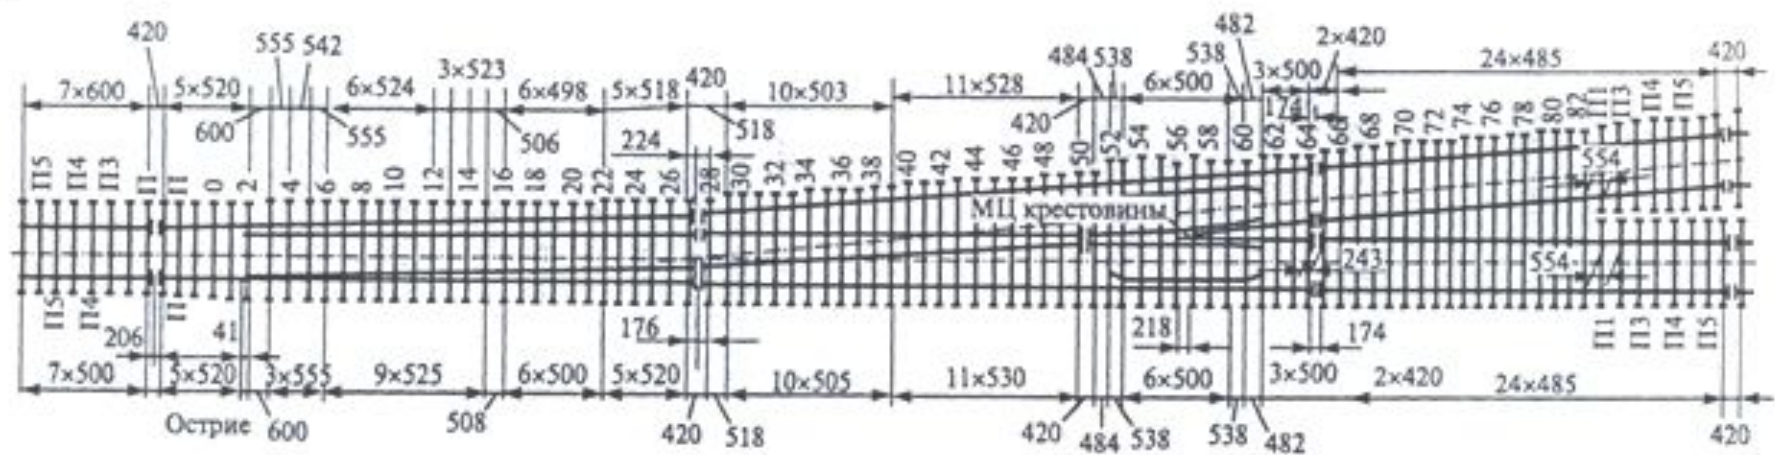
Этюра укладки (а) и схема разбивки (б) стрелочного перевода типа Р65 марки 1/11 на железобетонных брусках (проект 2750)
